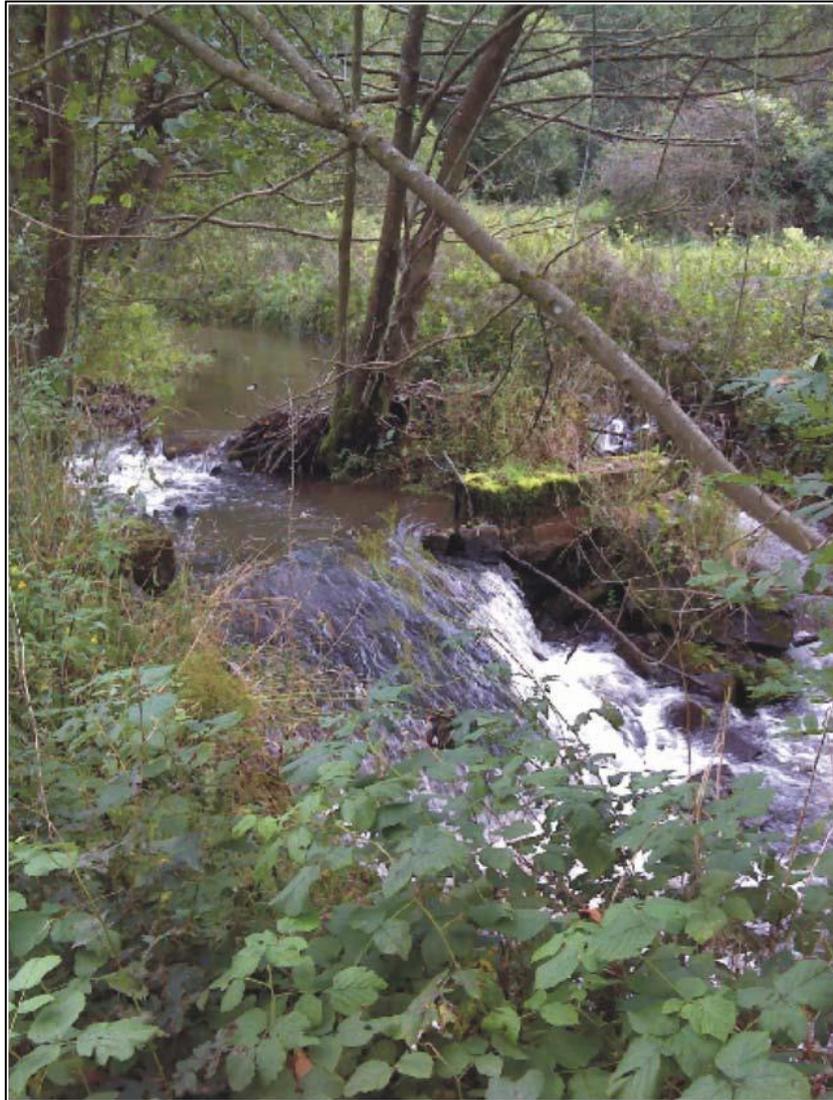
Reste eines Sohlabsturzes im Beckenraum
